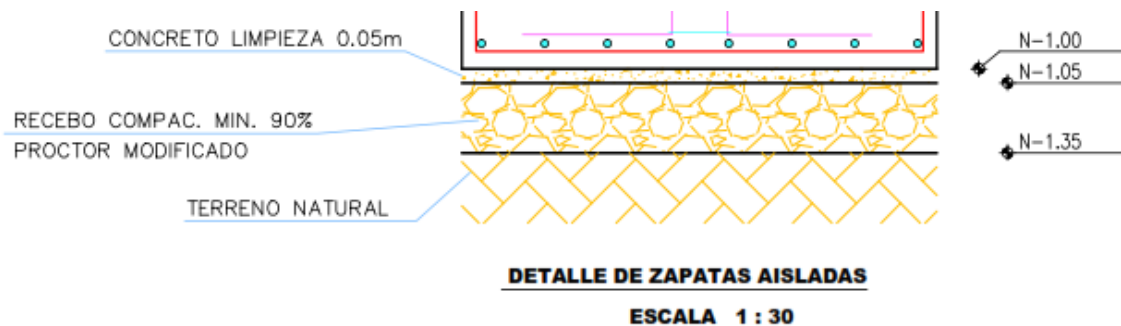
Detalle mejoramiento de suelo para zapata Fuente: Planos del proyecto
